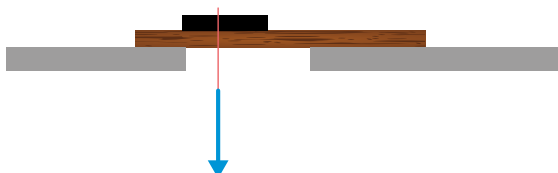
Anschlagen des Verbindungsmittels bei breiten Öffnungen, mit Querriegel und Verstärkungsholz (Grundriss)
